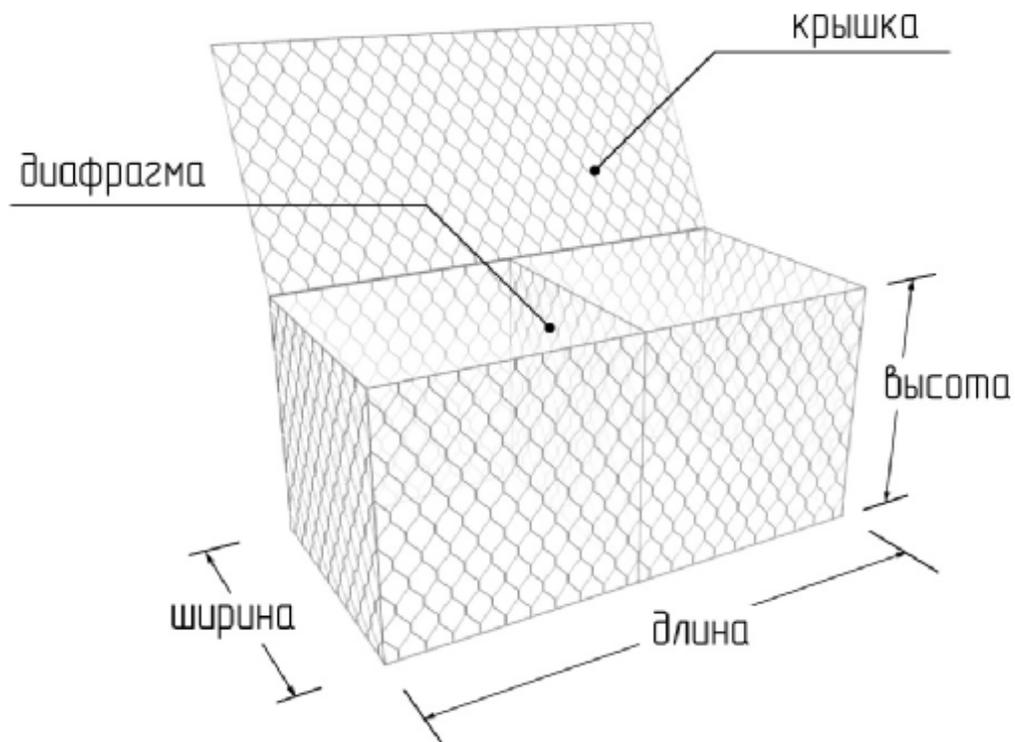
Конструктивная схема габионных конструкций коробчатой формы
